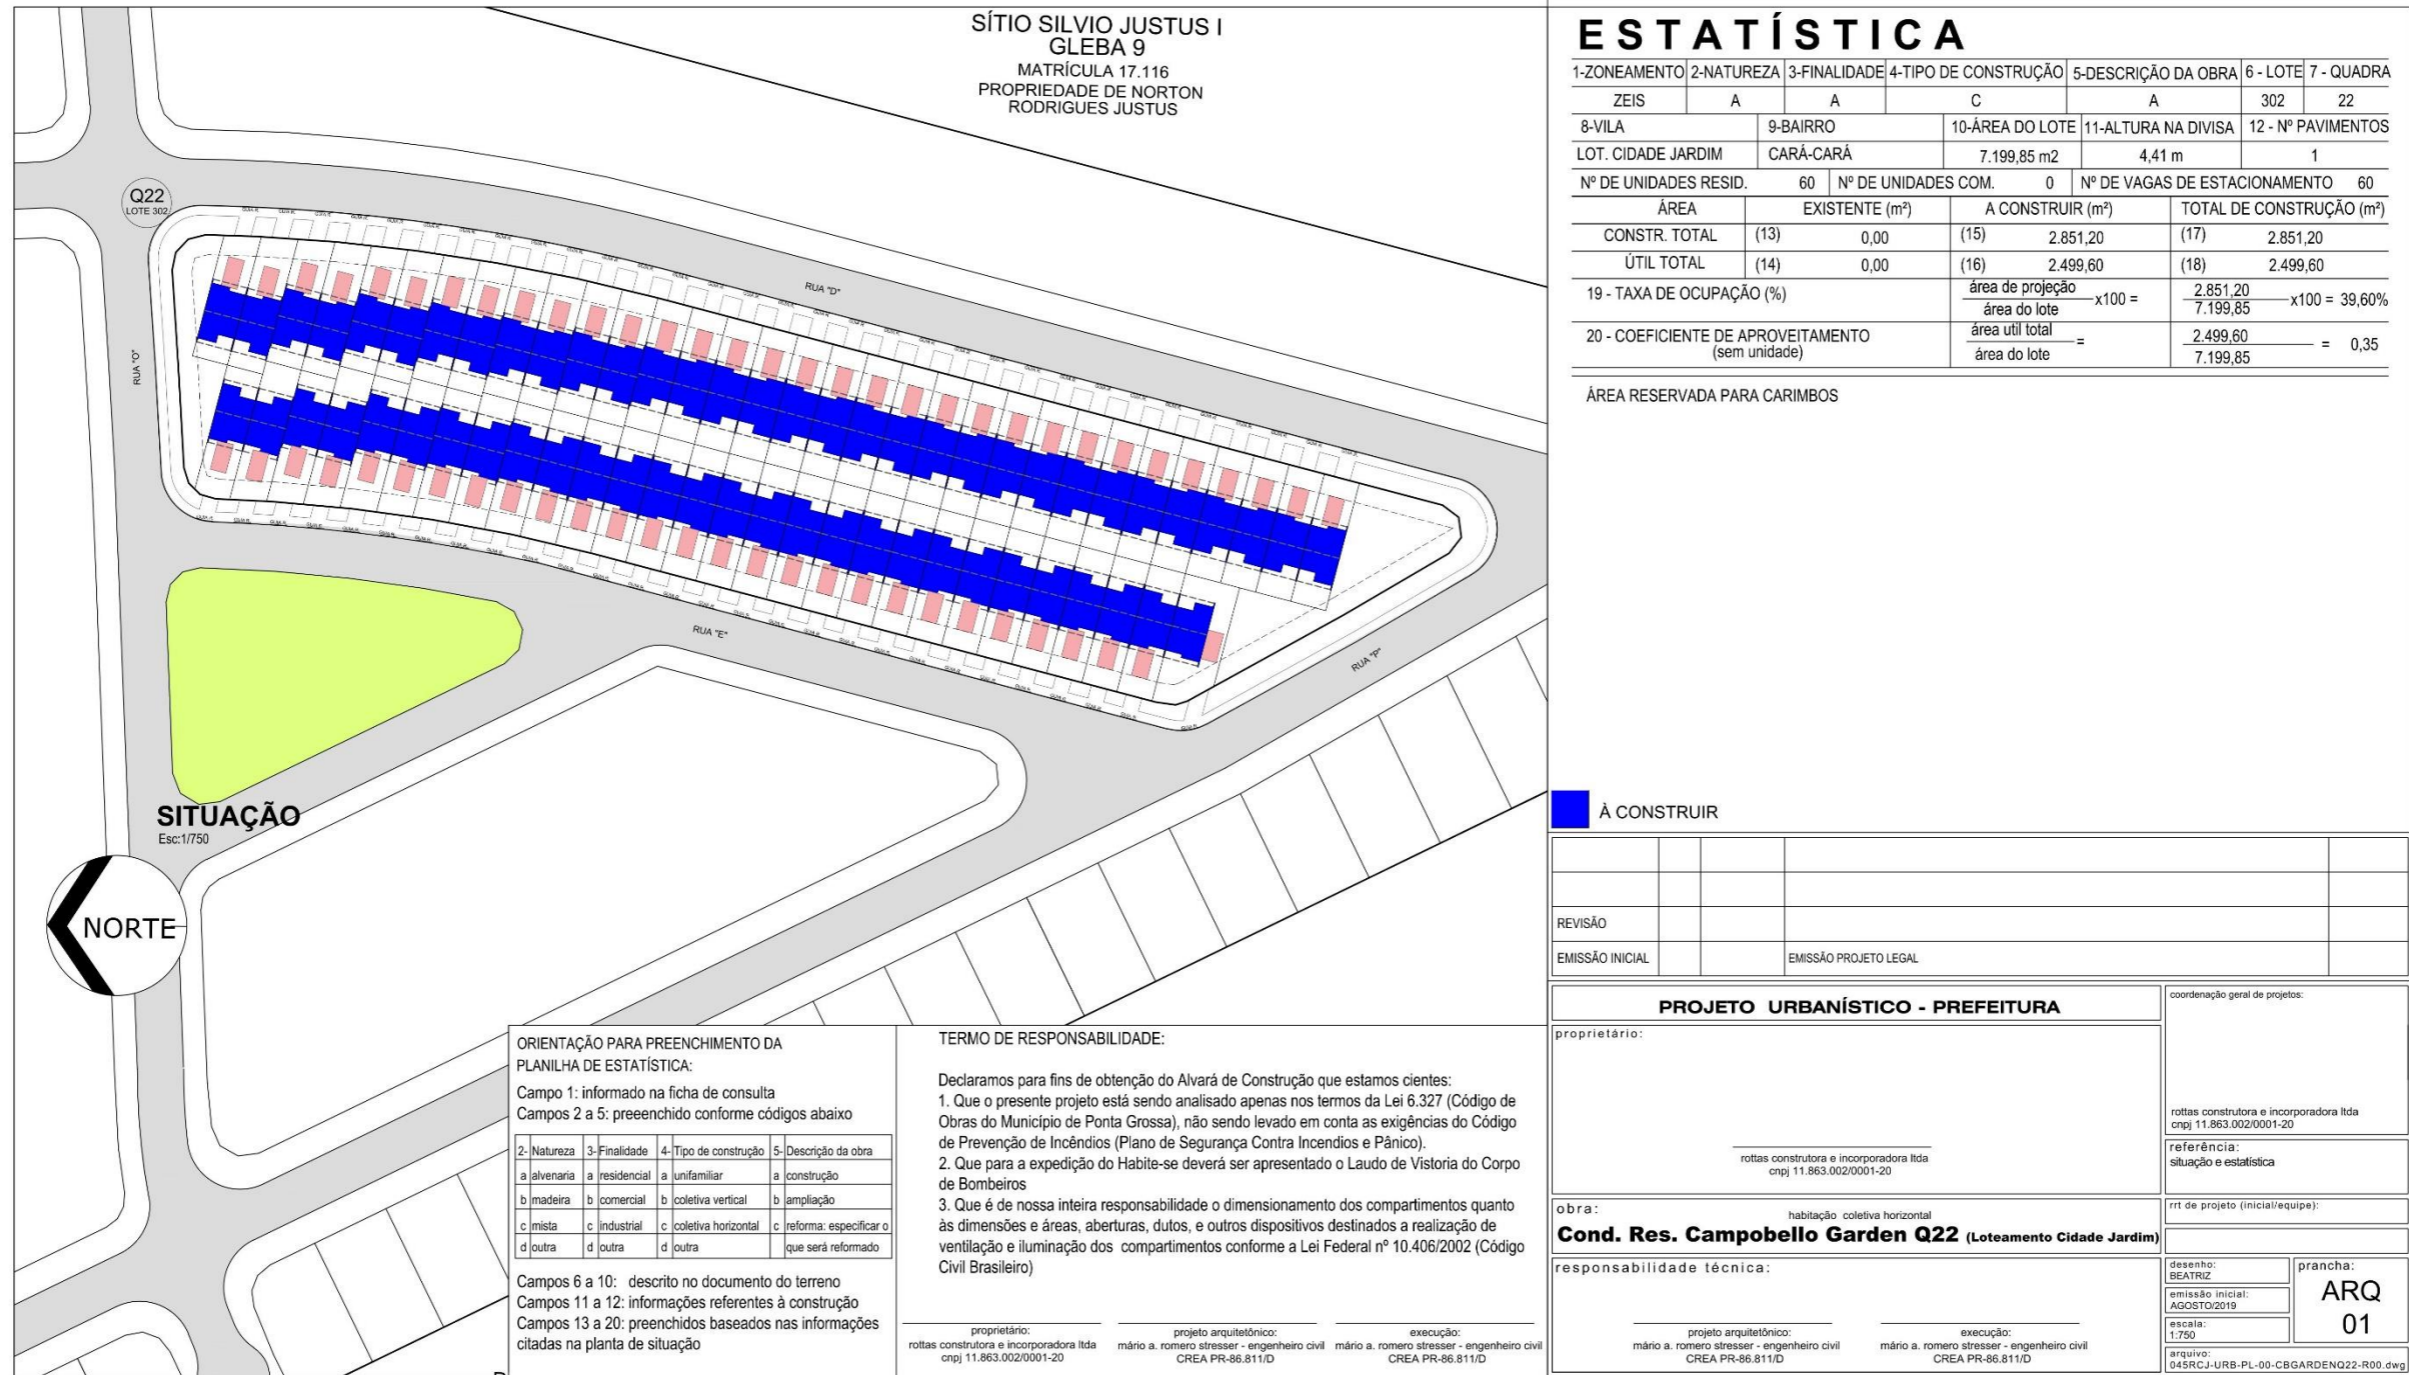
Projeto Urbanístico – Planta de Situação da Quadra 22 (Prancha 01).
